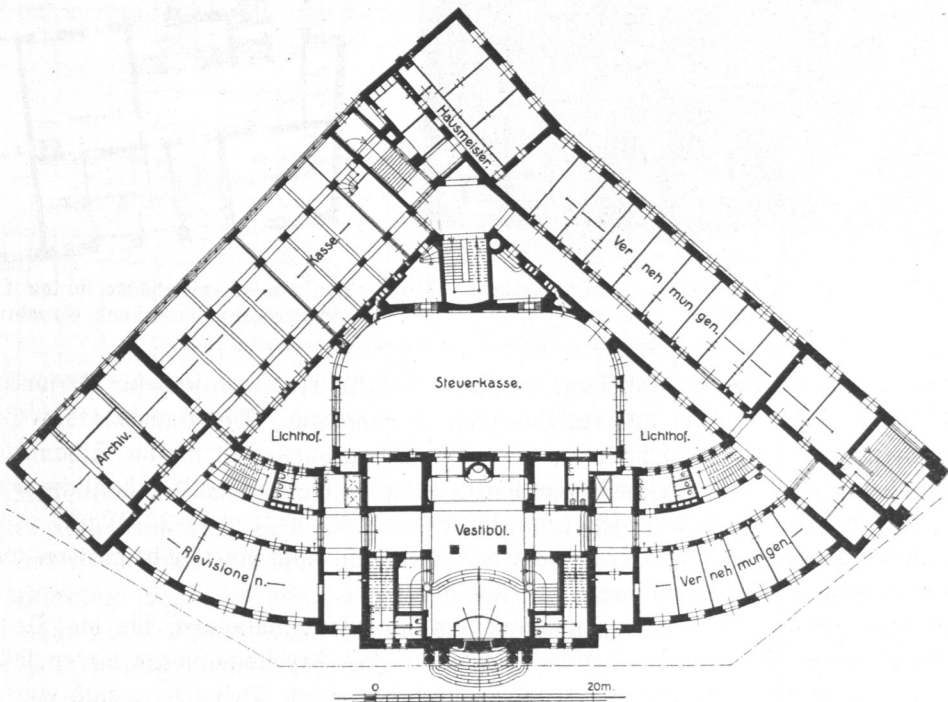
Steuergebäude, Grundriß, Erdgeschoß.
